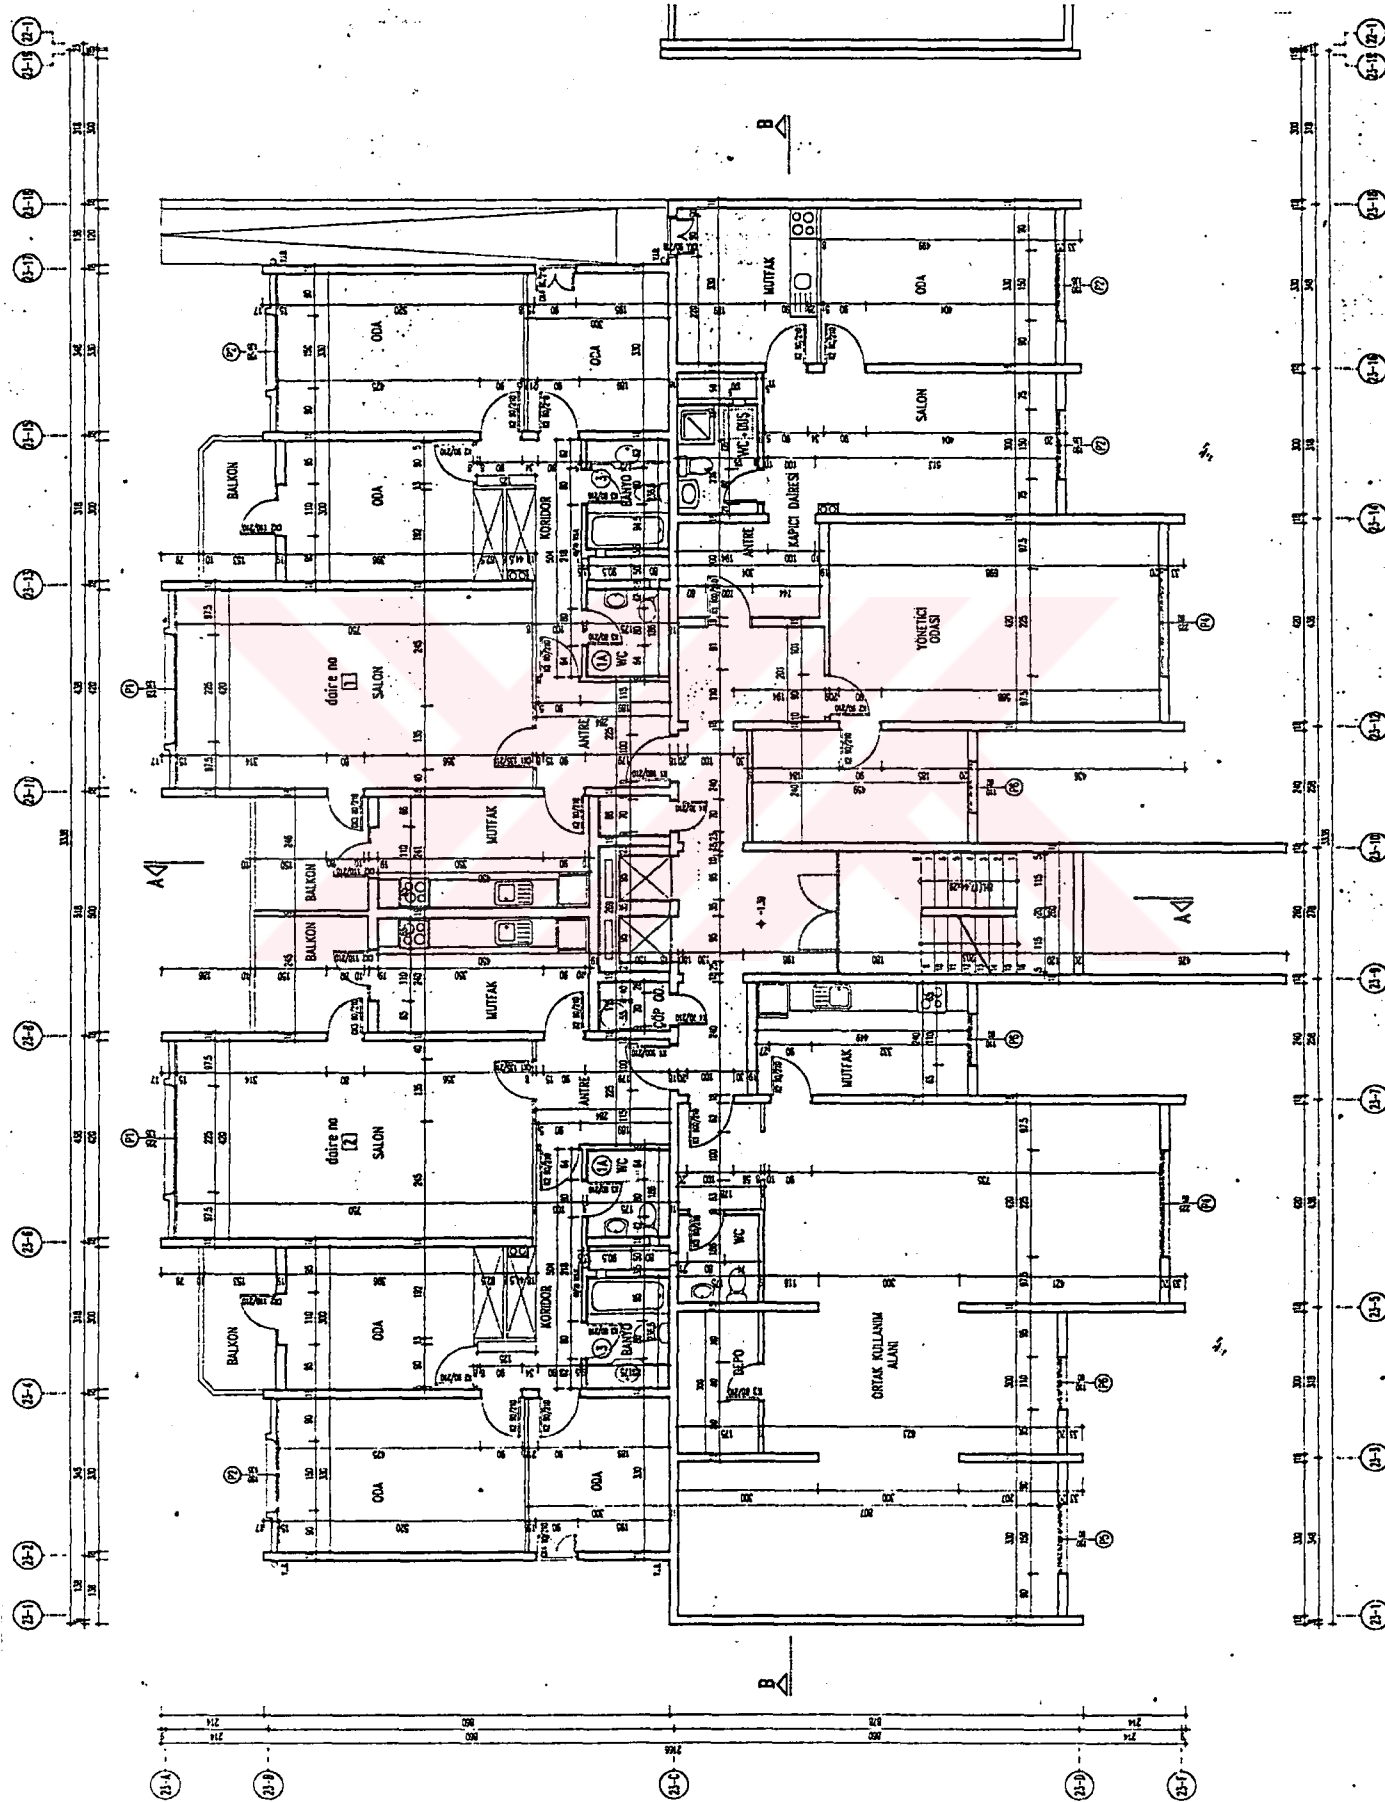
Ankara - Balgat Türk-İş Blokları Planı
